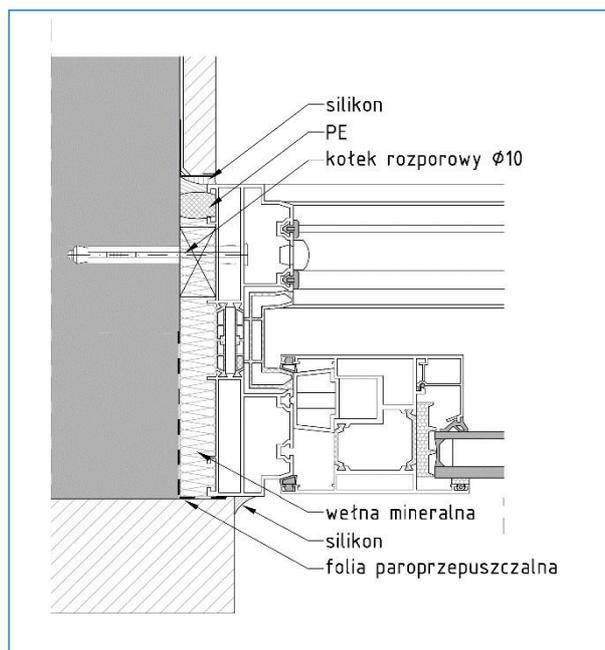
Esempio di montaggio della porta finestra in una parete solida isolata dall'esterno - sezione orizzontale
